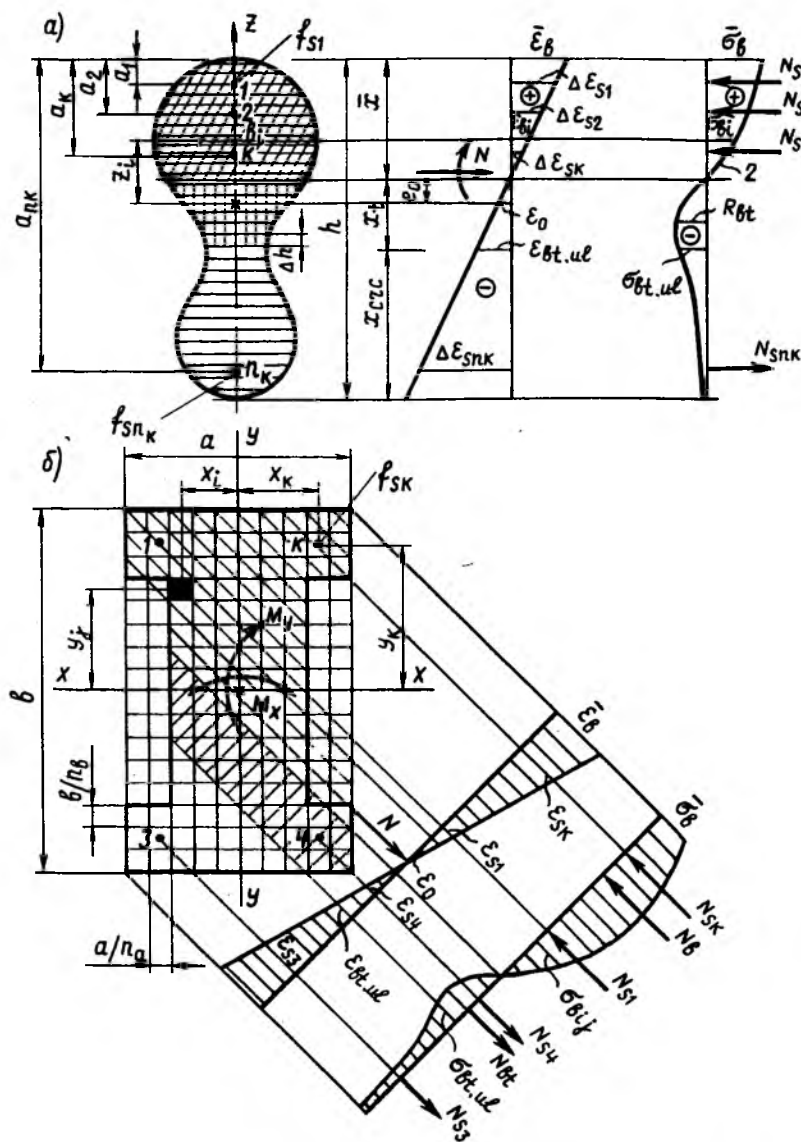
Схемы расчета железобетонных элементов при произвольной форме сжатой и растянутой зон бетона
